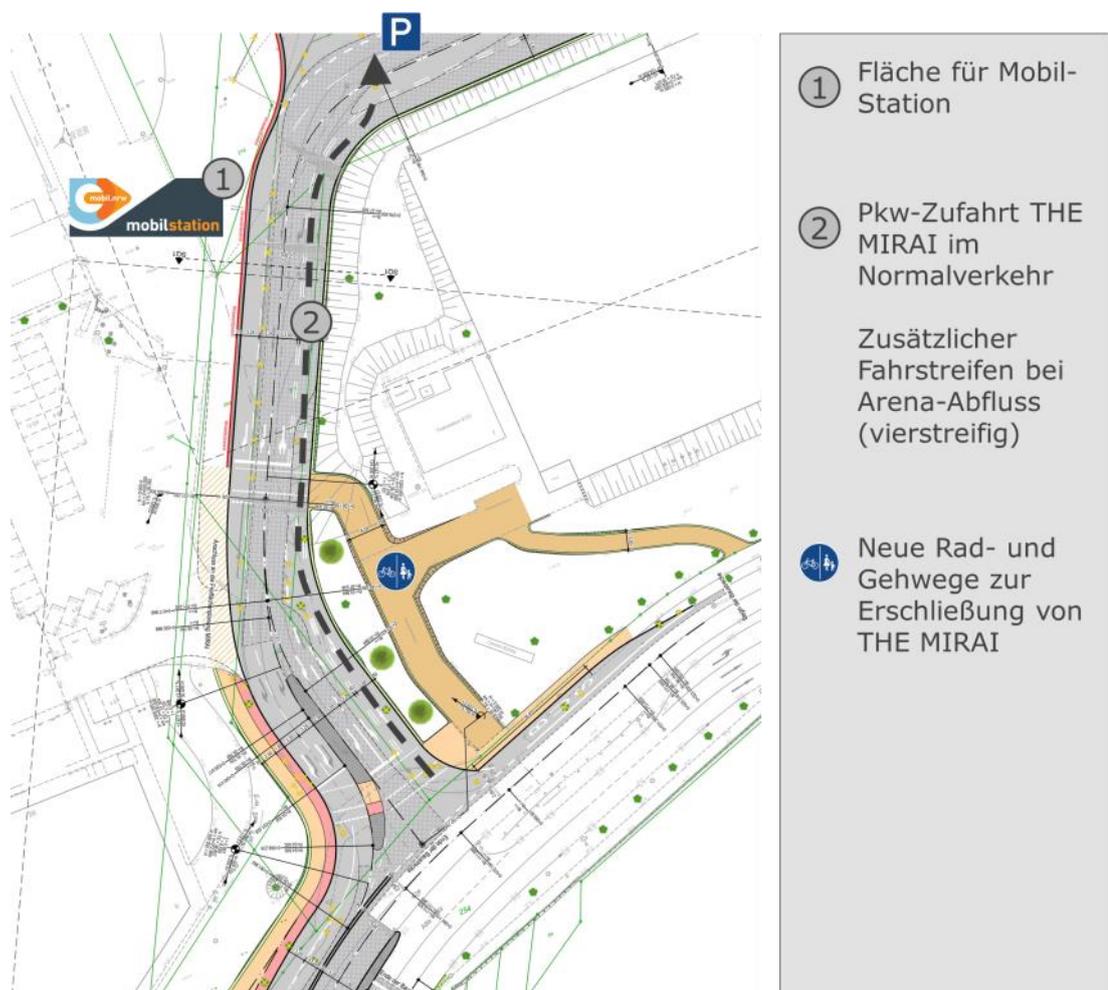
Detail Entwurfsplanung Zufahrt THE MIRAI
